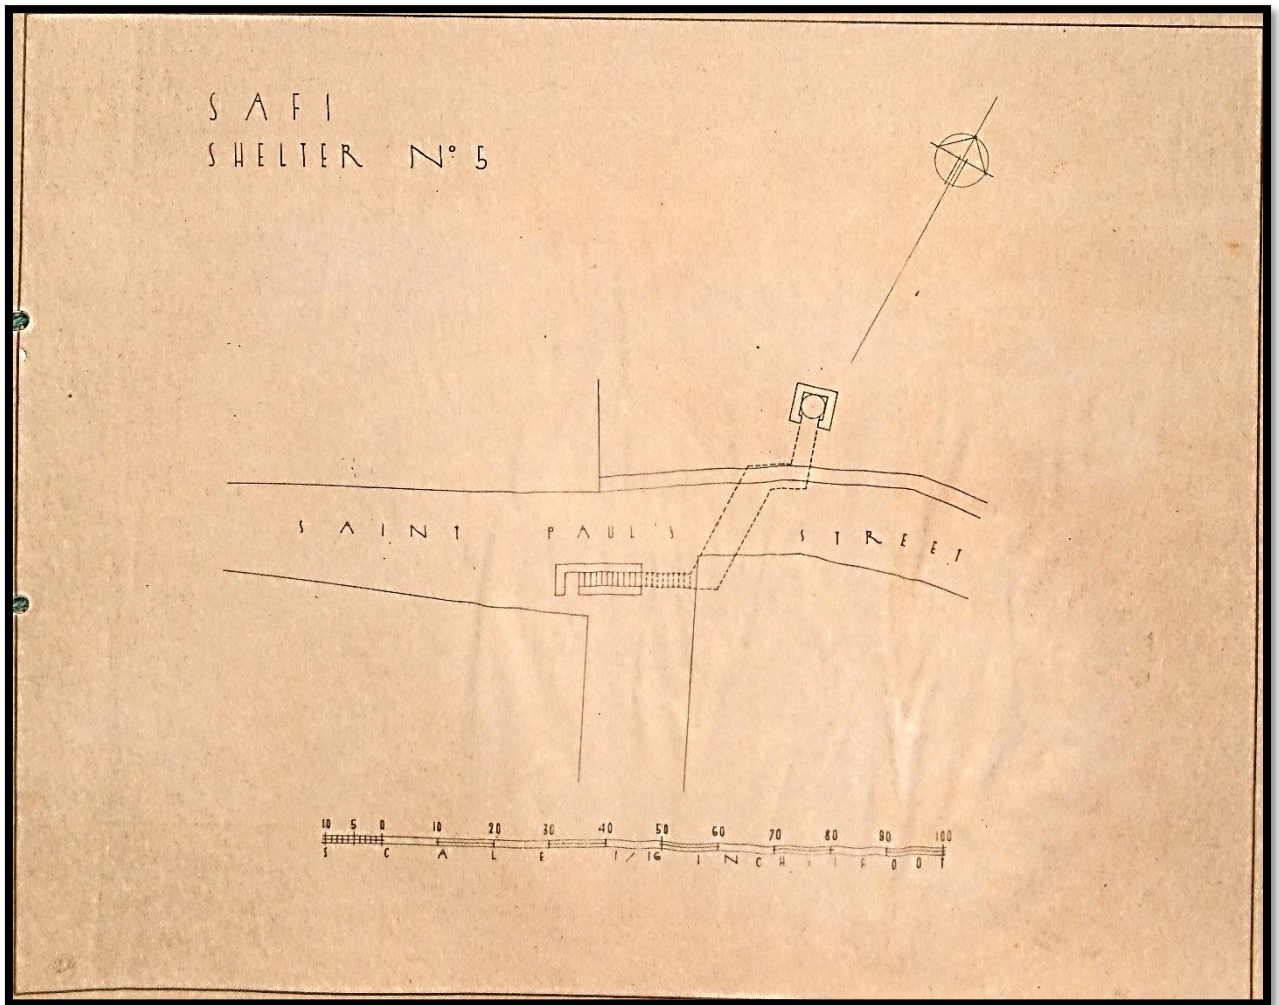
Planta do Abrigo nº5 "Saint Paul's Street."
